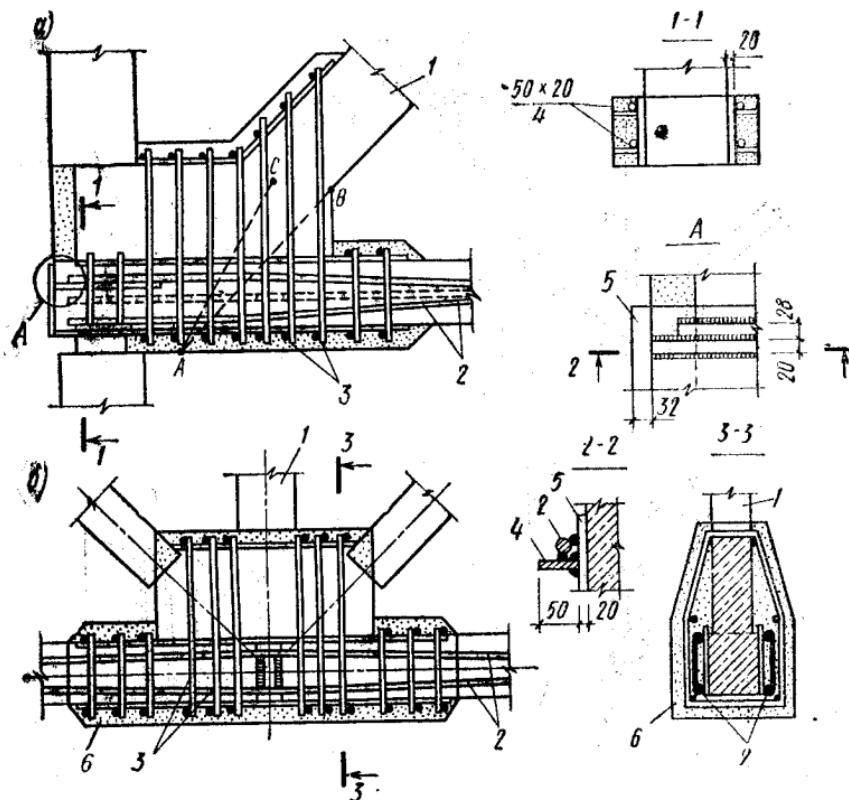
Усиление нижнего пояса и узлов стропильной фермы:
